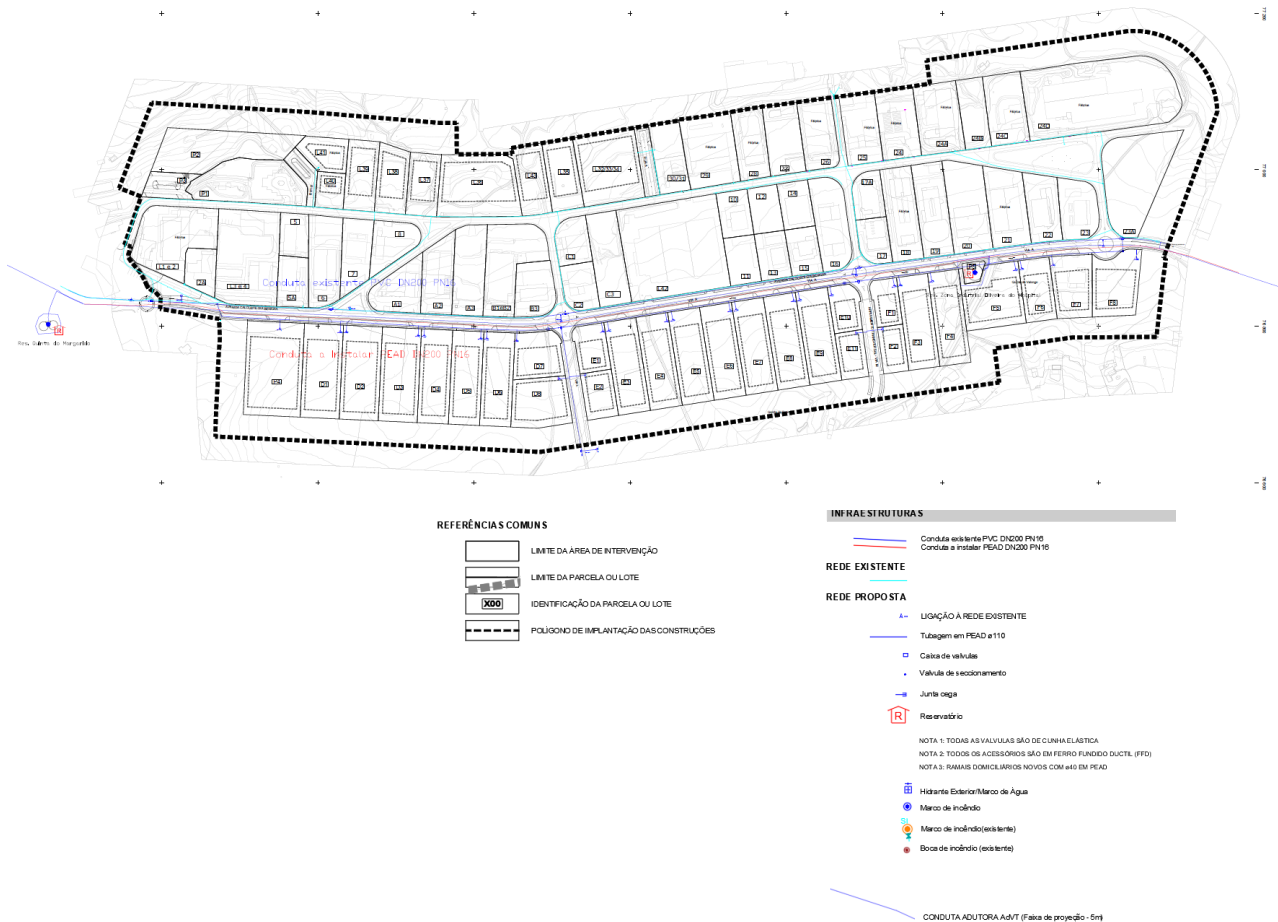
Representação da Planta de Infraestruturas – Rede de abastecimento de Água
